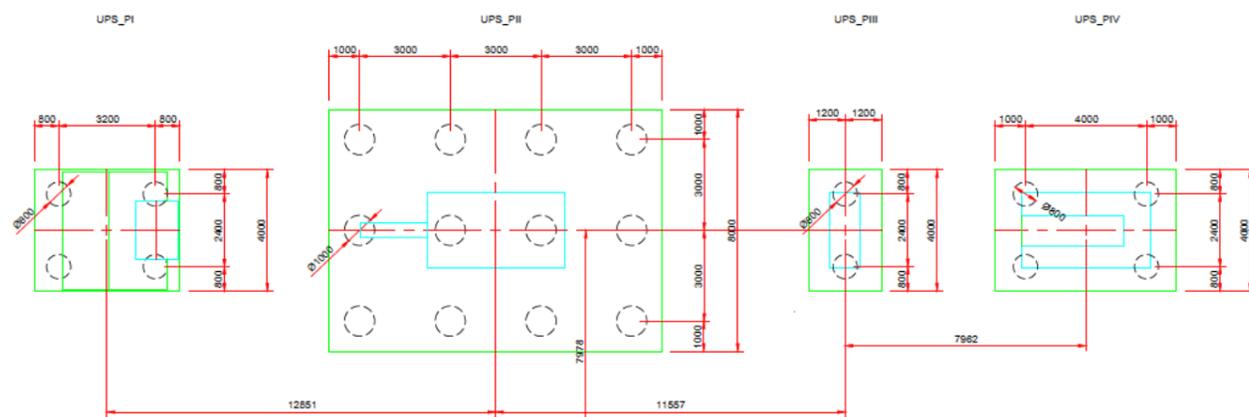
Fondations de la station UPS (source : Groupement POMA, 2018)
